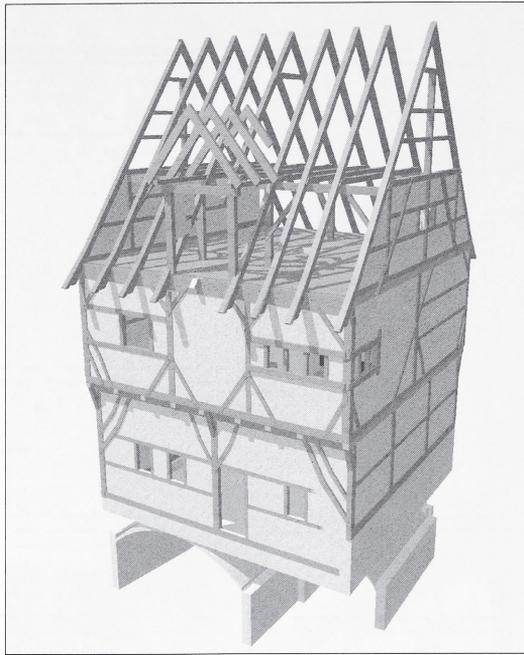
Schwäbisch Hall, Brüdergasse 5. Isometrische Ansicht des Hauses mit dem rekonstruierten Dachkerker, Baujahr 1393.
